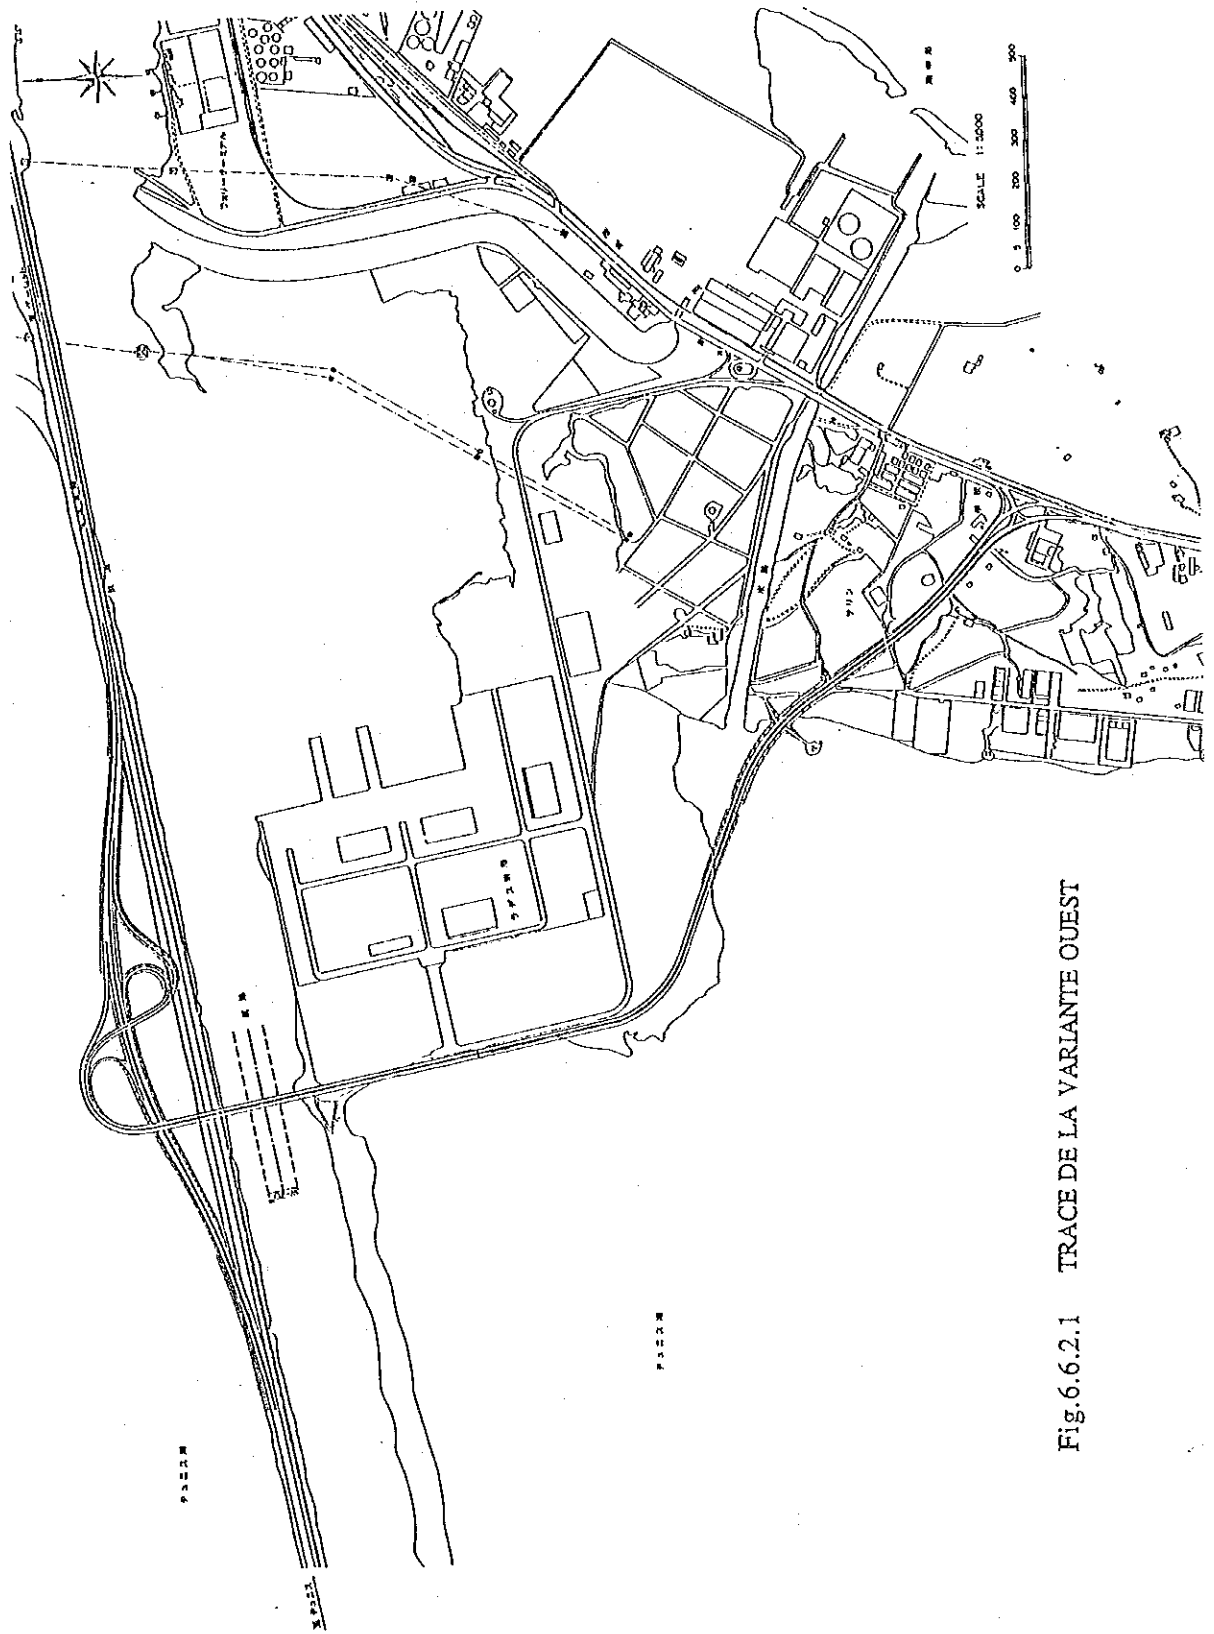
TRACE DE LA VARIANTE OUEST
